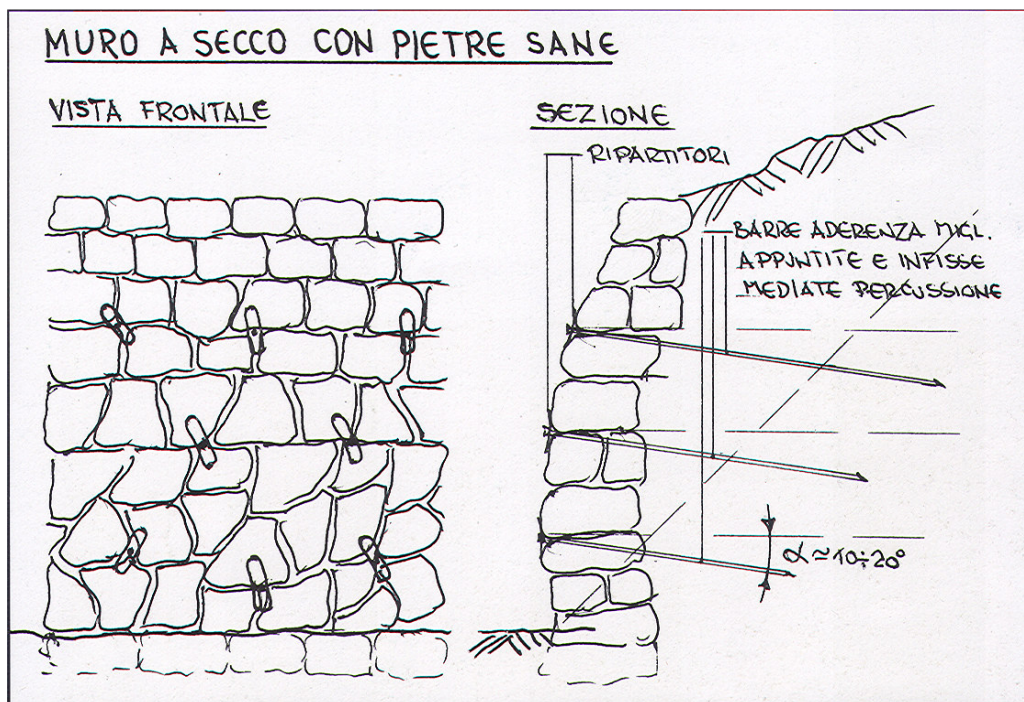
, schema di un muretto a secco dopo l'applicazione delle barre ad aderenza migliorata.
